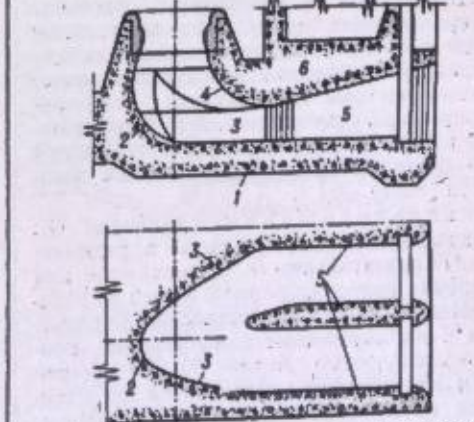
Элементы изогнутой отсасывающей трубы: 1 — фундаментная плита; 2 — тыловая стена колена; 3 — боковые стены колена; 4 — зона тора; 5 — бычки; 6 — перекрытие.
